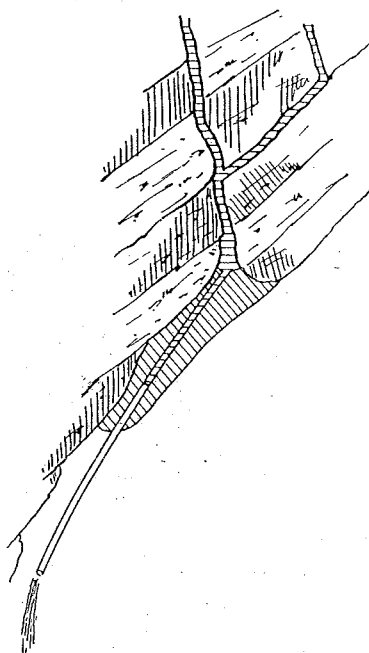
Successiva applicazione dell'impermeabilizzante e traslazione del tubo drenante.
